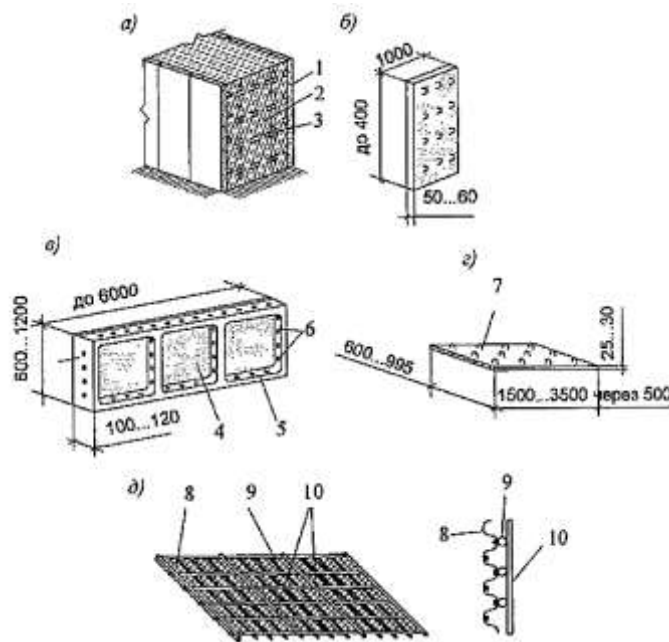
Несъемная опалубка: а — общий вид массива с опалубкой-облицовкой; б — железобетонная плита плоская; в — то же, ребристая; г — плоская армоцементная плита; д — армопакет; 1 — плита; 2 — бетон массива; 3 — армокаркас; 4 — шероховатая поверхность; 5 — ребро плиты; 6 — отверстия; 7 — плита с выступающими анкерами; 8 — тканая сетка; 9 — сварная сетка; 10 — прижимные прутки
